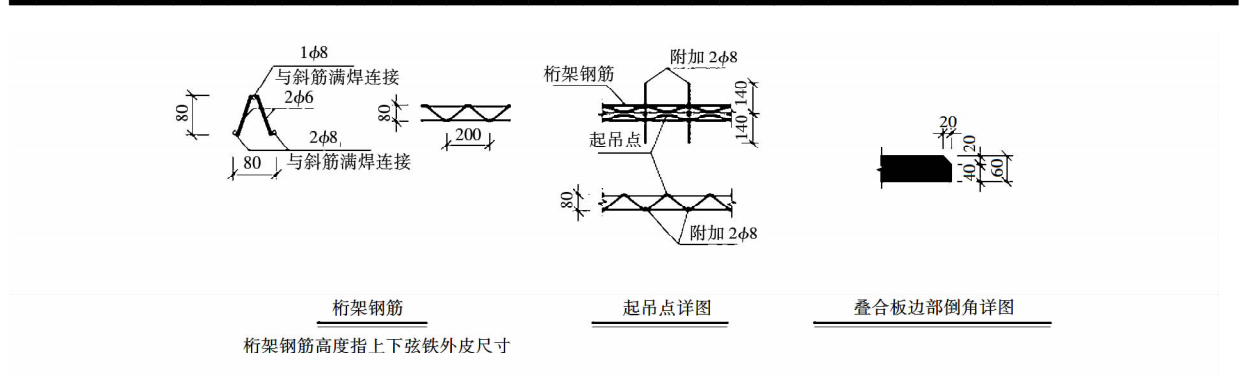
异形叠合板预制构件的关键点构造详图 (mm)
